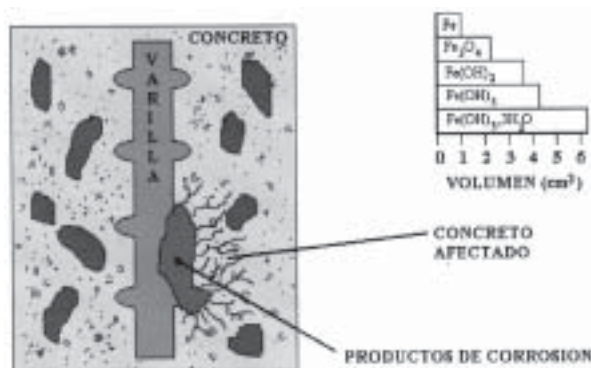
Efectos de la corrosión del acero en el concreto armado.
